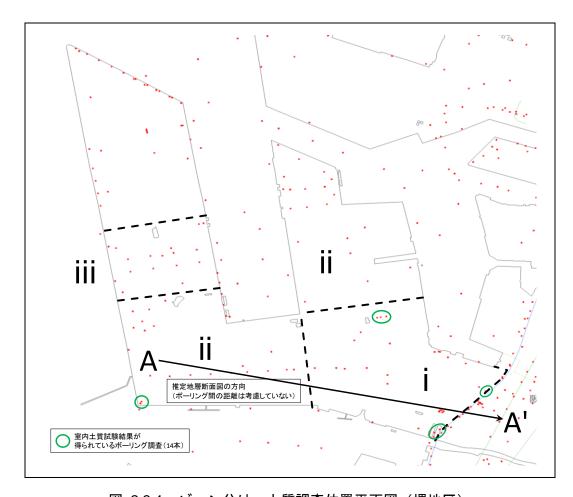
ゾーン分け・土質調査位置平面図 (堺地区)
